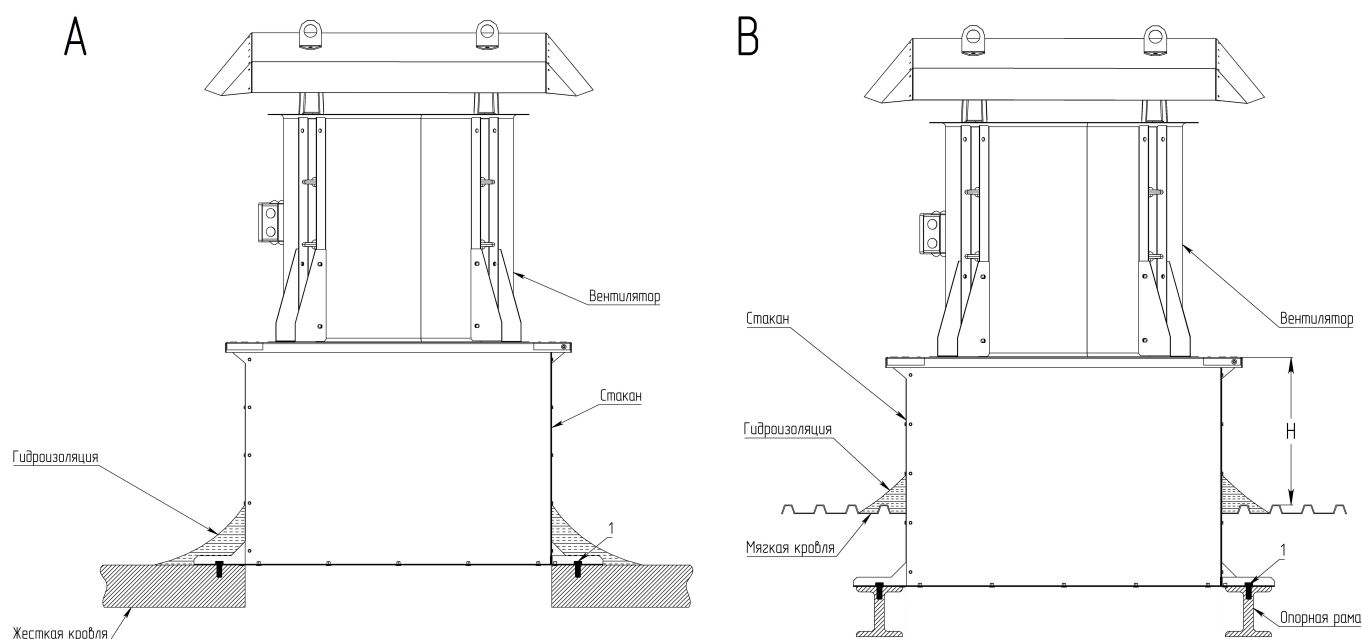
Монтаж на жесткой (А) и мягкой кровле (В)
